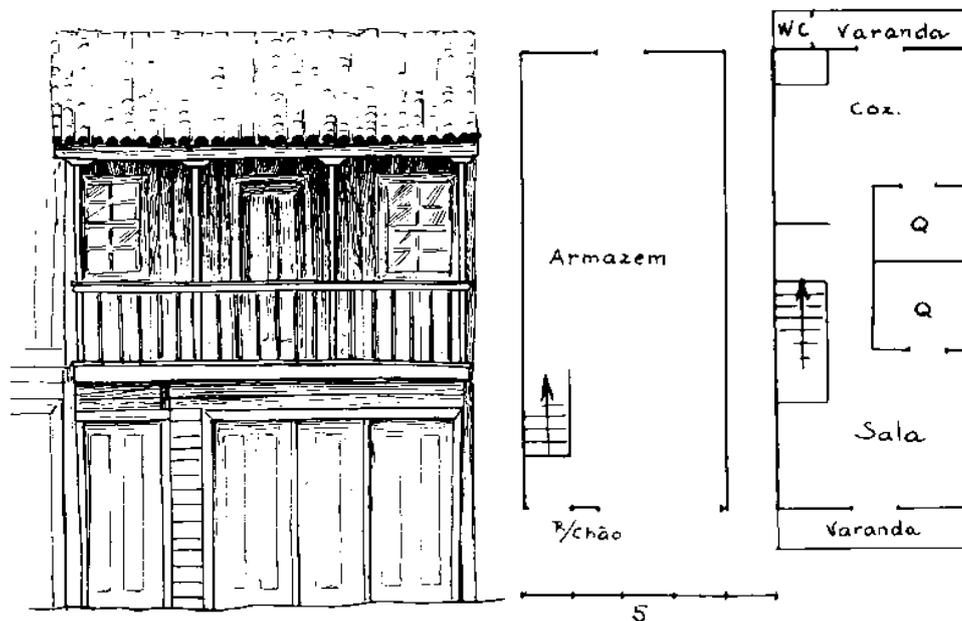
Alçado principal e plantas de palheiro do Furadouro (Disponível em: VEIGA DE OLIVEIRA & GALHANO, 2000).
